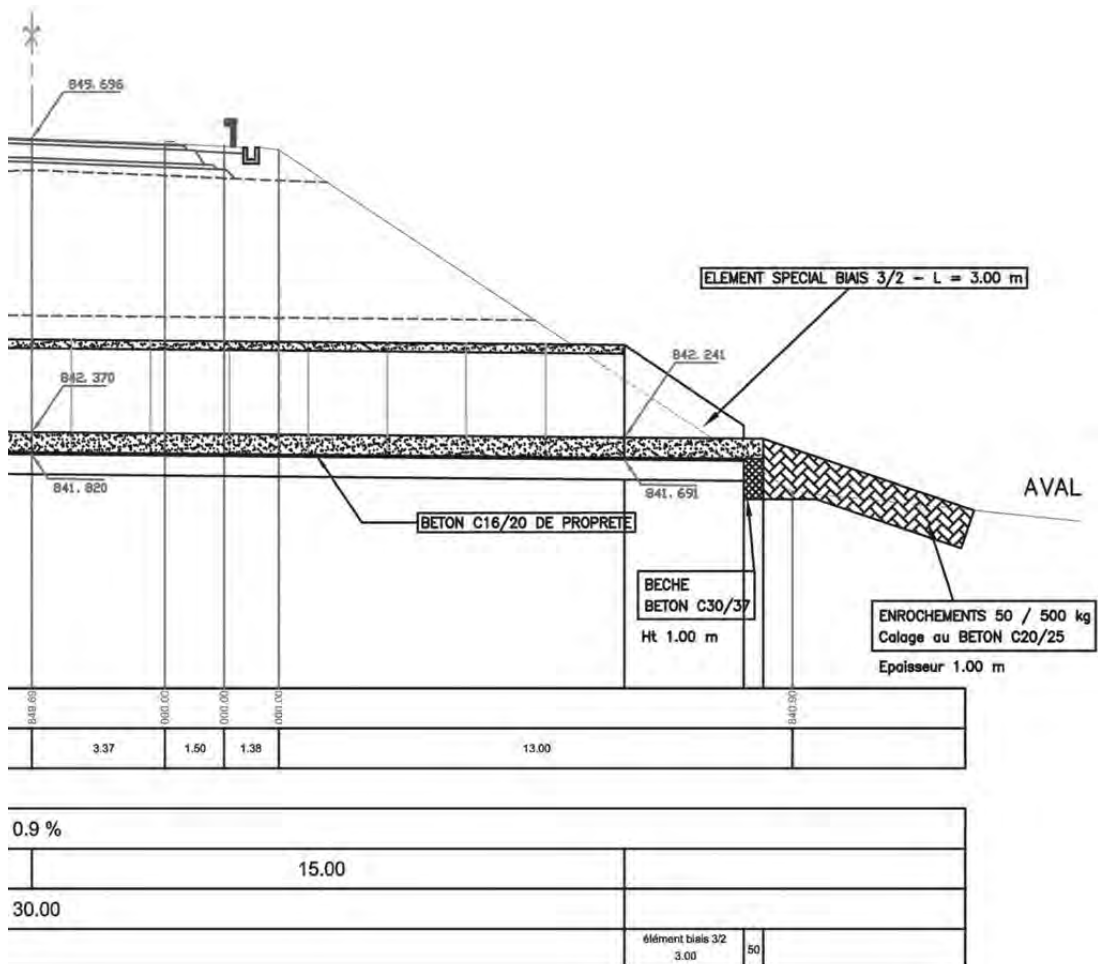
Coupe longitudinale d'un ouvrage de rétablissement. (Voir cahier couleur p.88-89)
